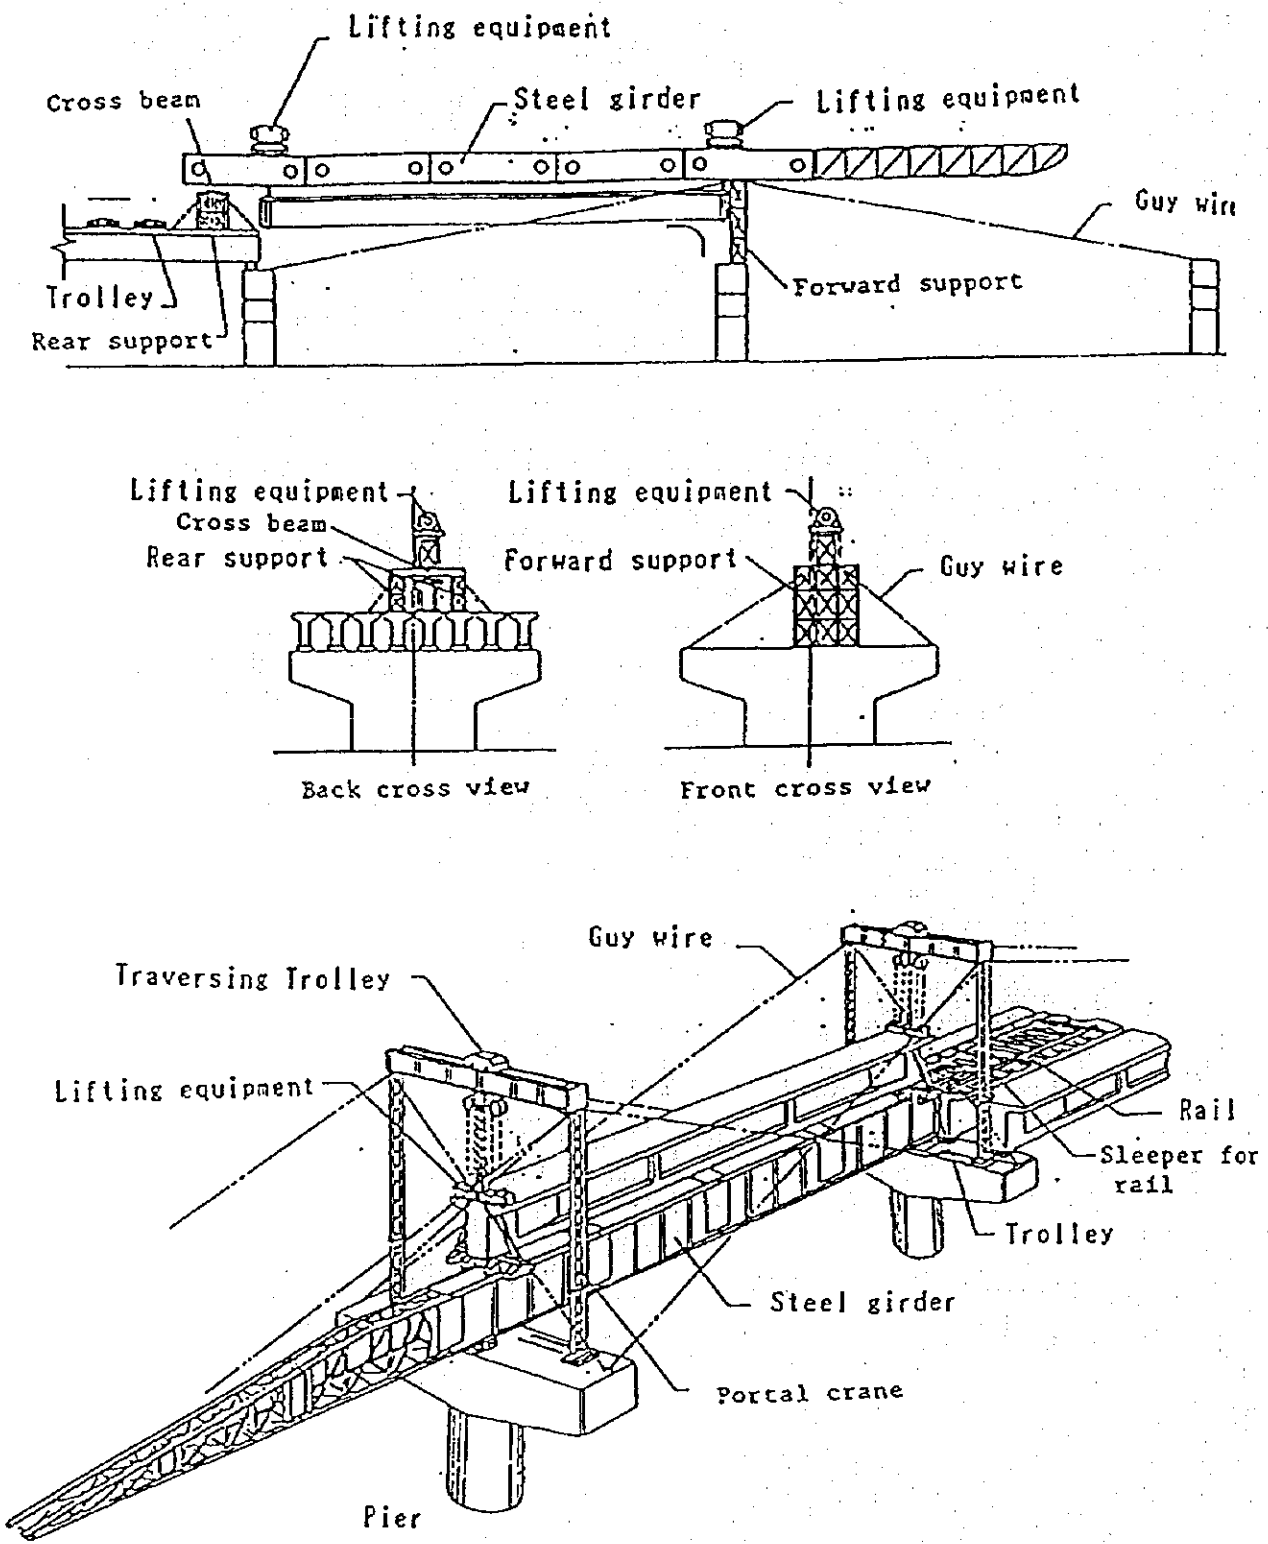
Montaje mediante una Viga Lanzamiento de Acero
